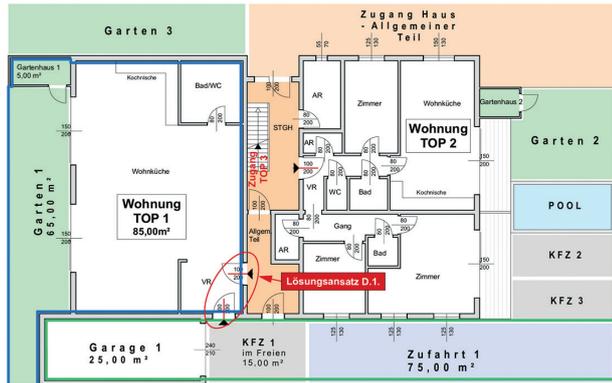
Grundriss zu Fallbeispiel D.1
